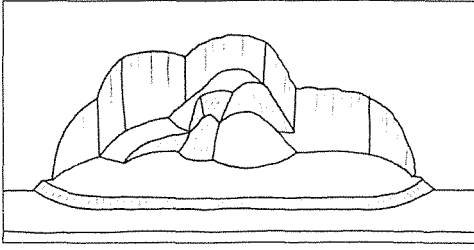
Ana kademe sahasının kademe yolu yapılması planlanan tarafında yapılan galeri ateşlemesi
